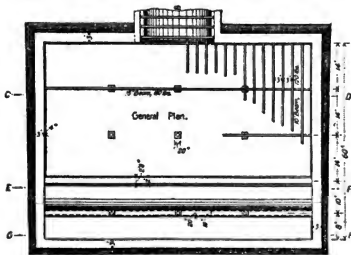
Grundriss der Fanggrube und der Sperrkammer.
